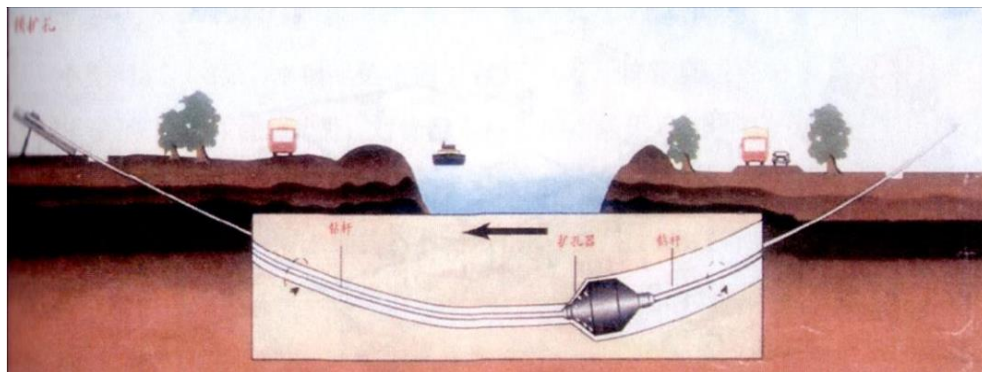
拉管穿越施工钻预扩孔过程断面示意图
